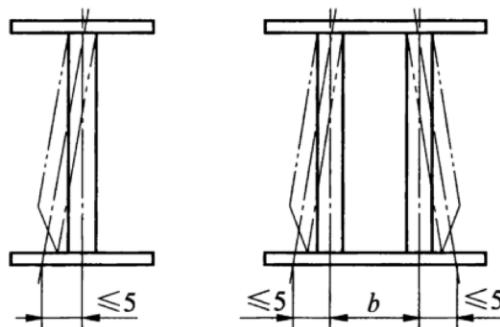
腹板横向倾斜偏差 (单位: mm)
